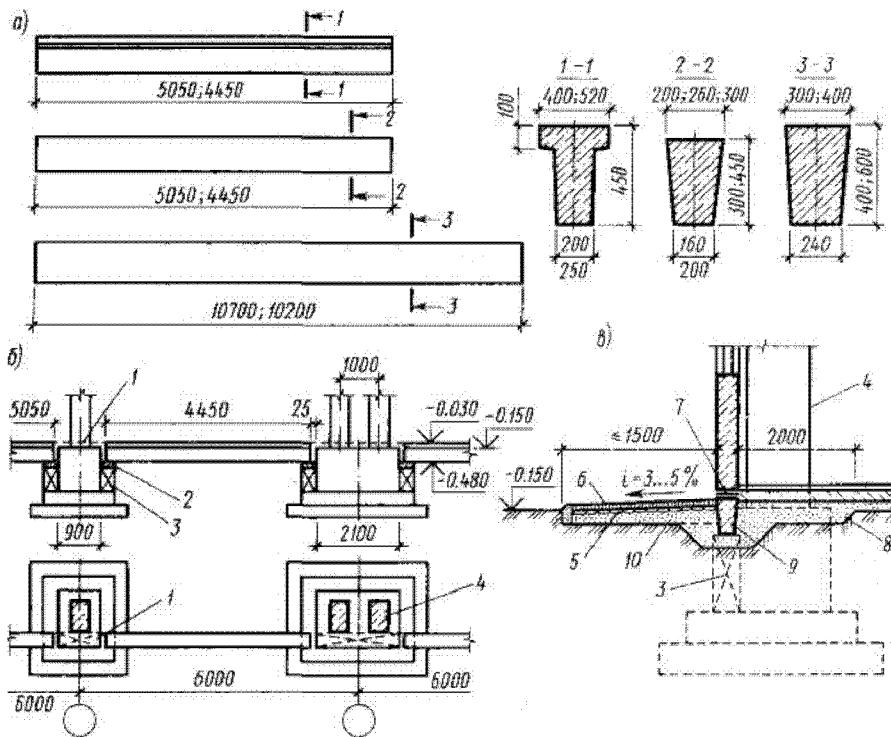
Збірний фундамент під залізобетонні колони.
